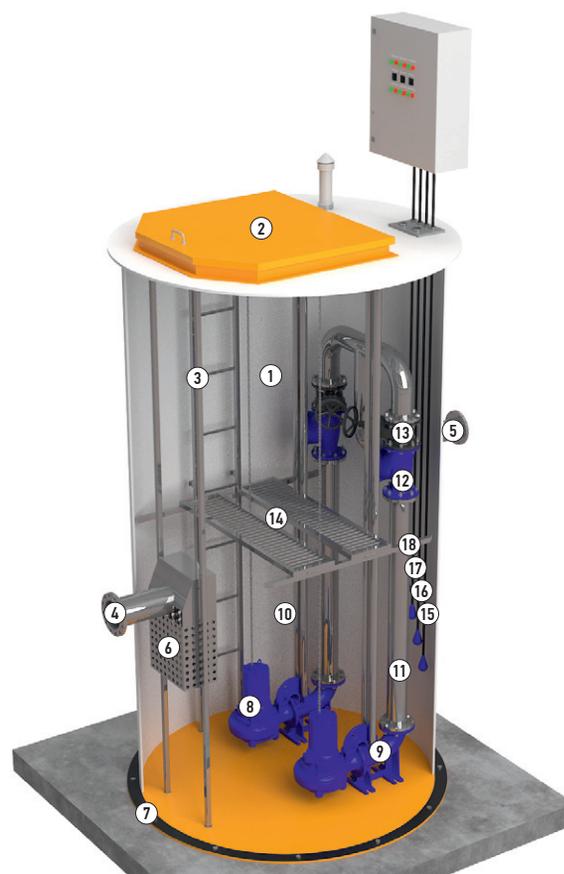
Состав оборудования КНС: 1 – корпус; 2 – люк; 3 – лестница обслуживания; 4 – подводящий патрубок; 5 – напорный патрубок; 6 – сороулавливающая корзина для сбора крупных включений; 7 – основание станции (юбка для крепления анкерными болтами); 8 – насосный агрегат; 9 – автоматическая трубная муфта; 10 – направляющие трубы для опускания насосов; 11 – напорный коллектор; 12 – обратный клапан; 13 – задвижка обрезиненная клиновидная; 14 – площадка обслуживания; 15 – поплавковый выключатель (выключение при понижении уровня жидкости – нижний уровень); 16 – поплавковый выключатель (включение первого насоса); 17 – поплавковый выключатель (включение второго насоса); 18 – поплавковый выключатель (авария при переполнении)
